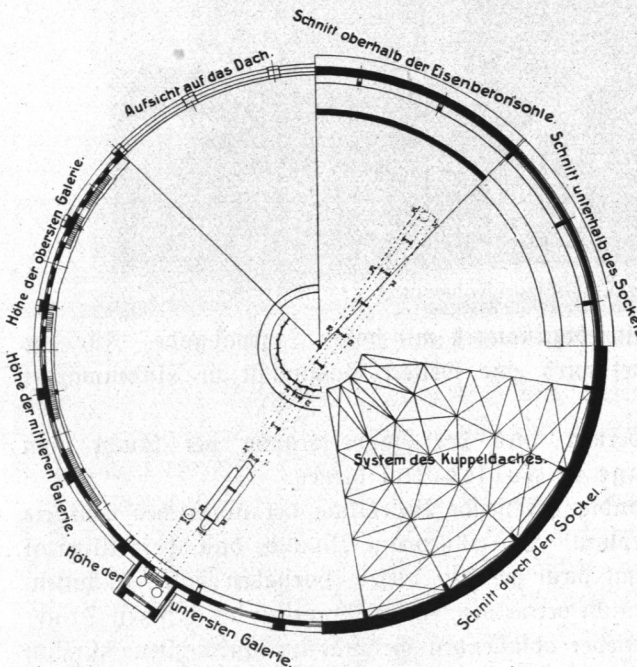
Gasbehälter Fuhsbüttel, Grundriß.
